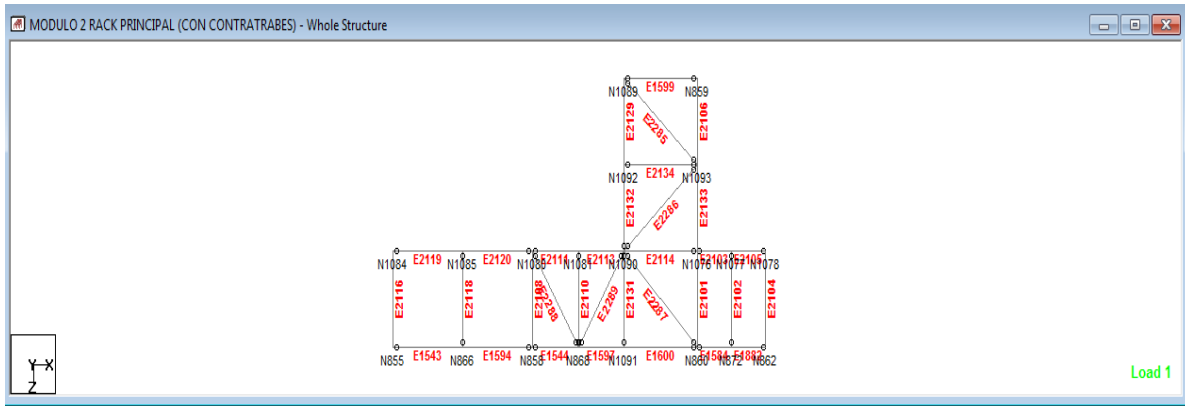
Modelo analítico planta estructural nivel 7.00
